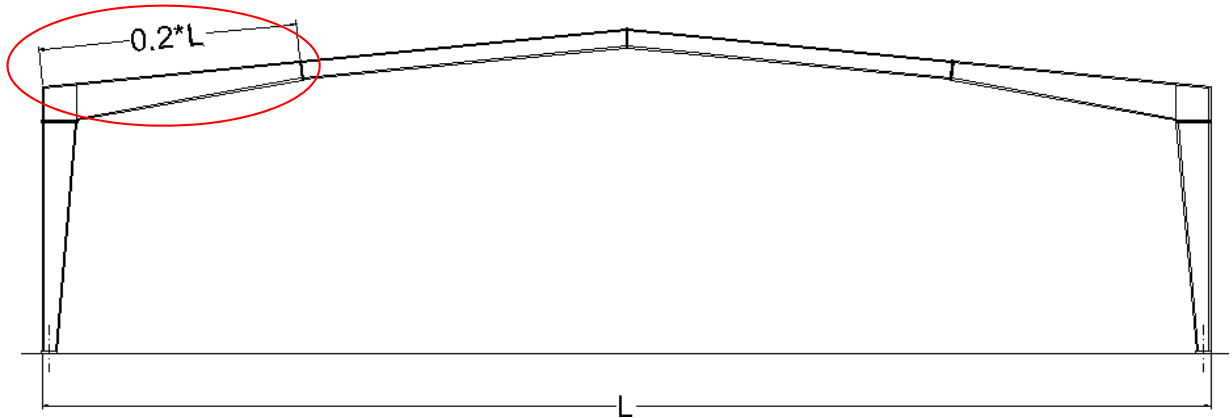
Aplicación de viga de inercia variable en pórtico armado.
